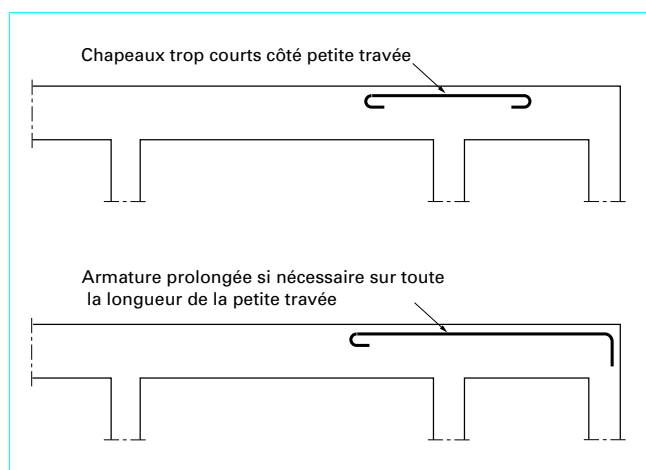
Longueur des chapeaux sur appuis encadrés par des travées de portée très différente
